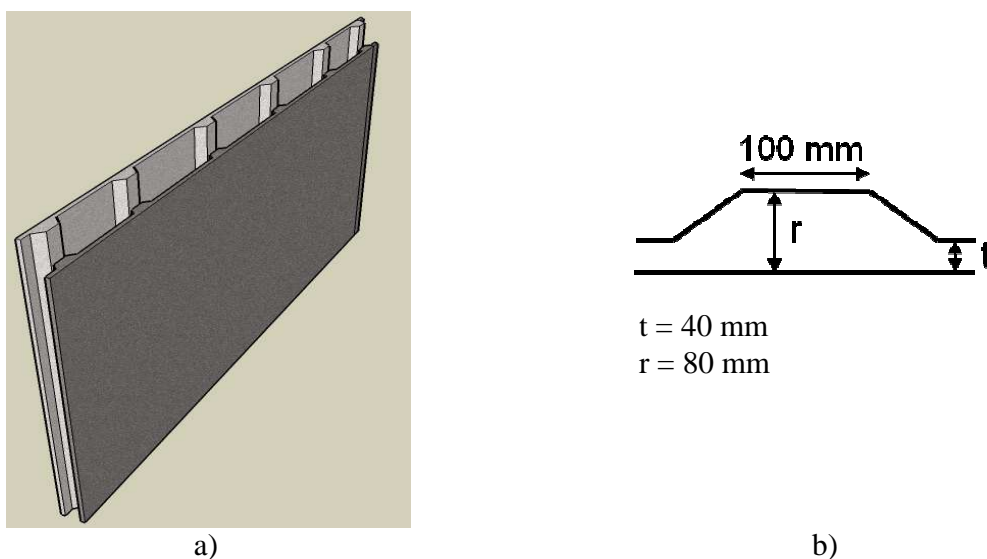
Conceito de painéis sanduíche nervurados. a) Vista dos painéis; b) dimensões das nervuras dos painéis de BACRFA.
